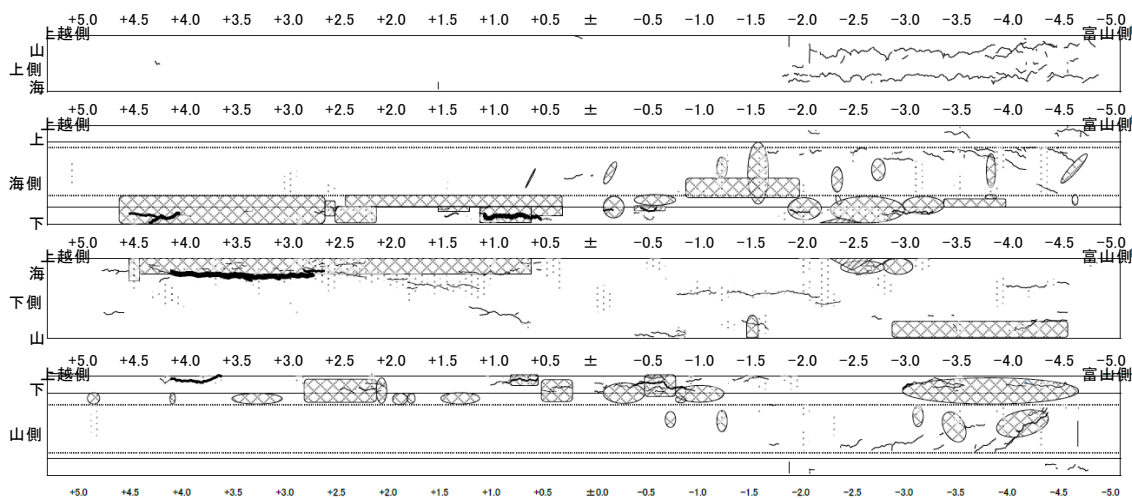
B 桁の載荷前のひび割れ性状（網掛け：浮き・剥離，ドット：錆汁）
